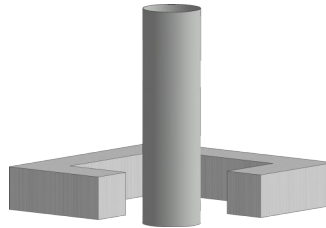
Masivdecke - Trockeneinbau - Mineralwolle mit Brandschutzbeschichtung
